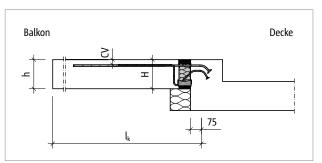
Schöck Isokorb® T Typ KL-O: Statisches System
